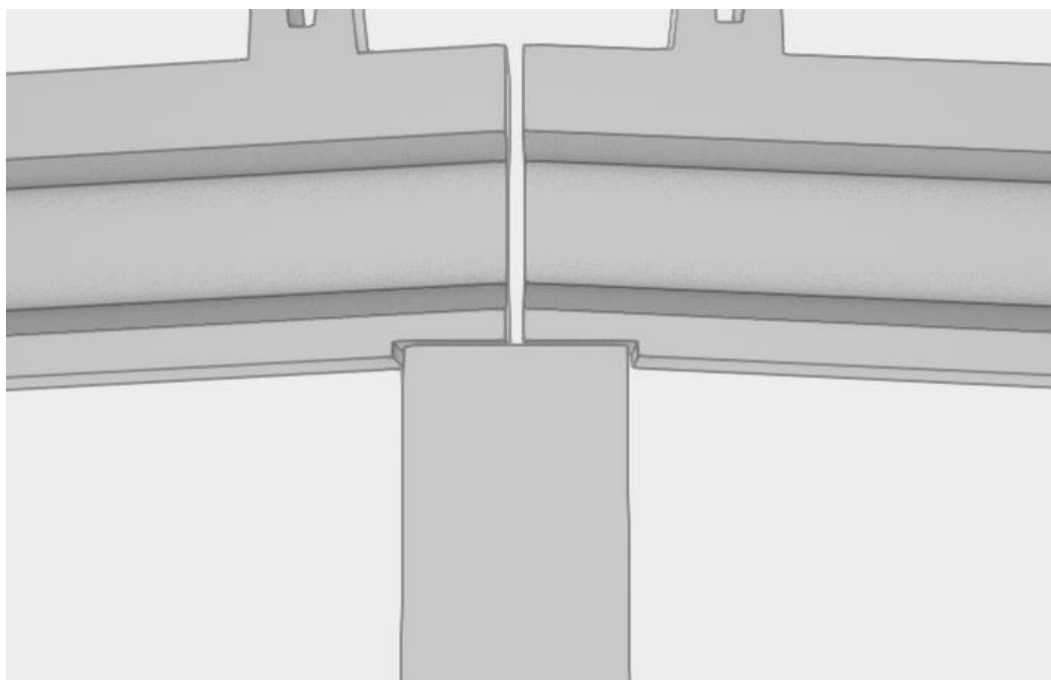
Pilar pré-fabricado de concreto apoiando viga de cobertura.
